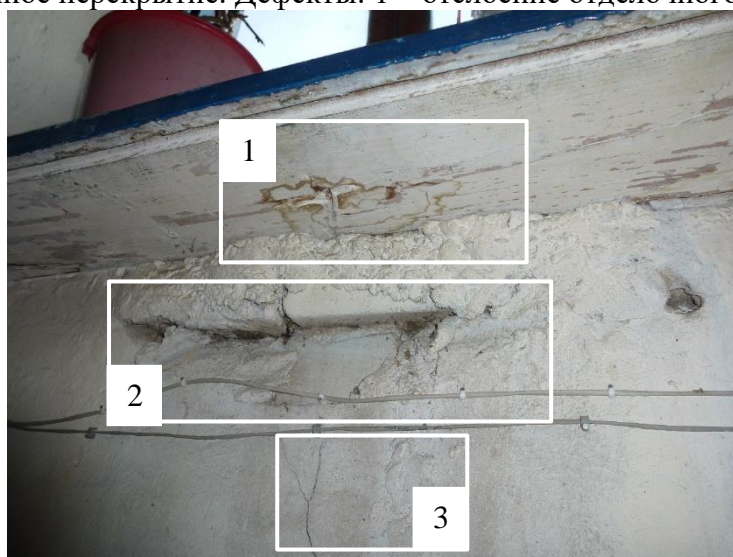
Наружная стена под оконным блоком. Дефекты: 1- следы протекания; 2 - вымывание раствора кирпичной кладки; 3 – сквозные трещины.
